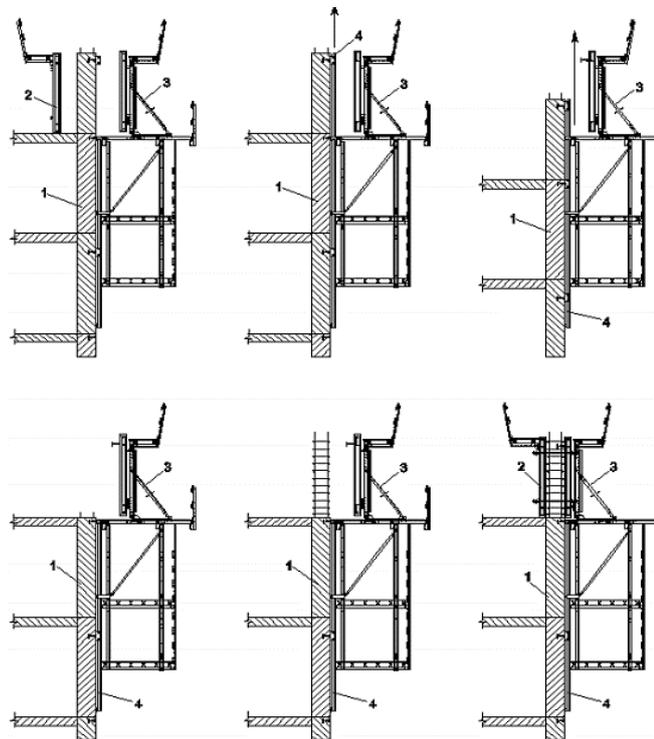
Схема перемещения подъемно-переставной опалубки [3 – 13]
